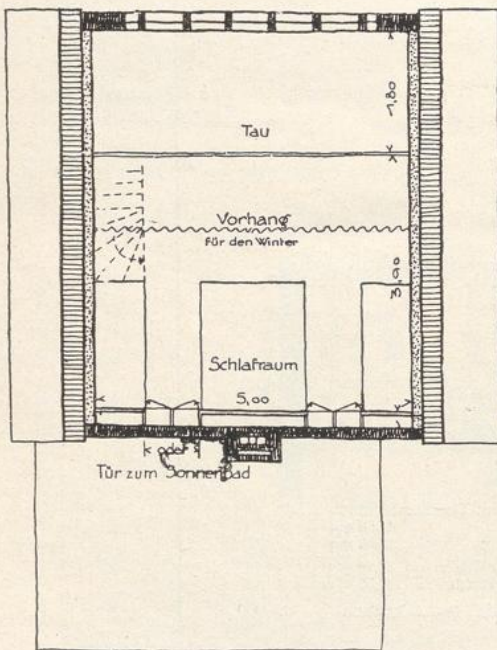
Grundriß des Dachgeschosses. (1:100)
